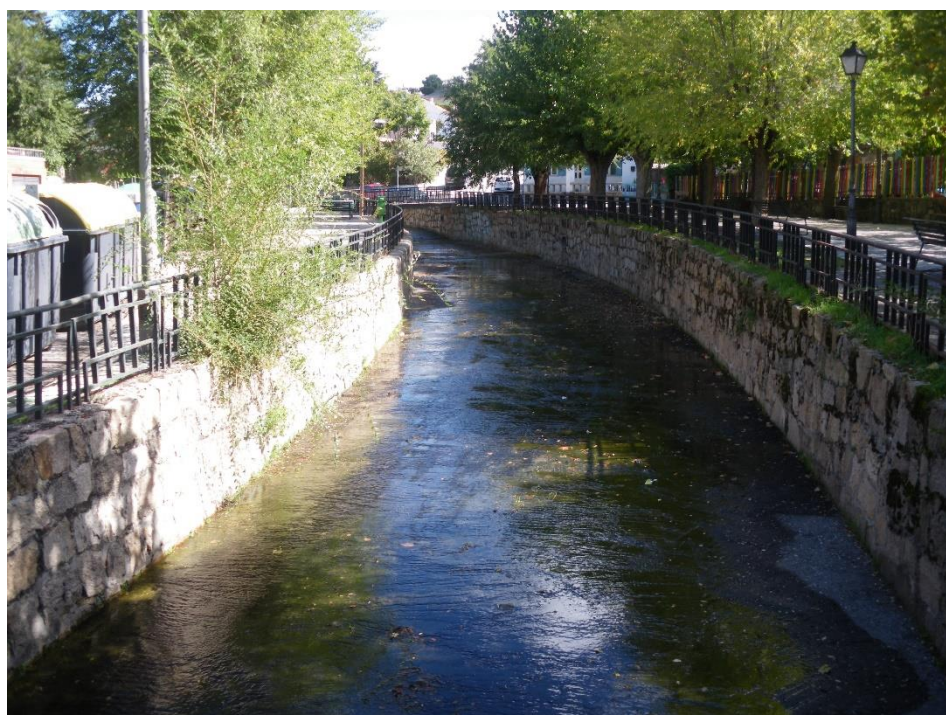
Canalización del arroyo del Cortecero (hacia aguas arriba) en la calle del Arroyo Cortecero.
